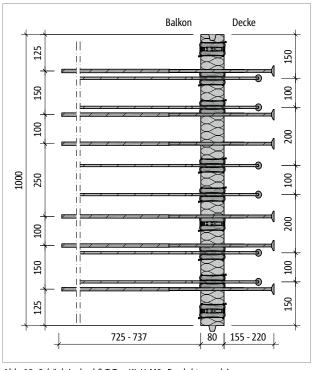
Schöck Isokorb® T Typ KL-U-M2: Produktgrundriss
